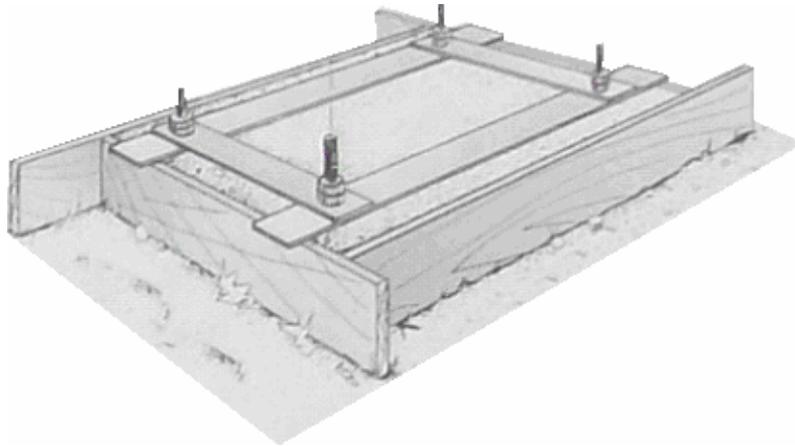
El hormigón se vierte hasta que quede rasante en el encofrado. Obsérvese que los pernos deben sobresalir.
